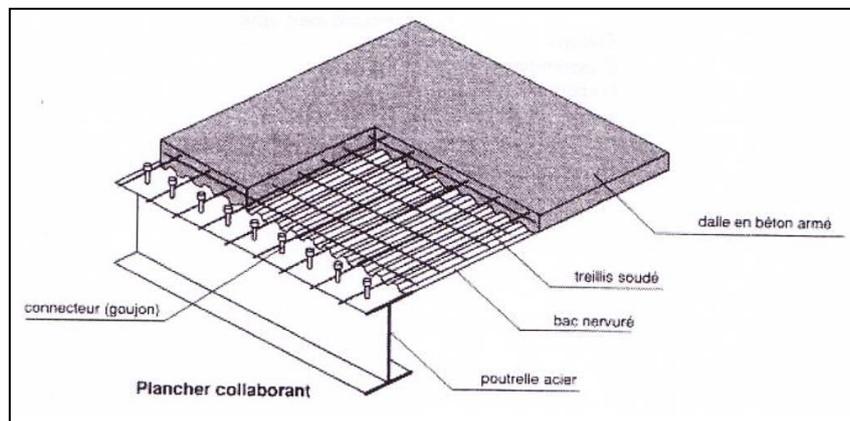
Détail n°03, Plancher collaborant Source : Les auteurs.
